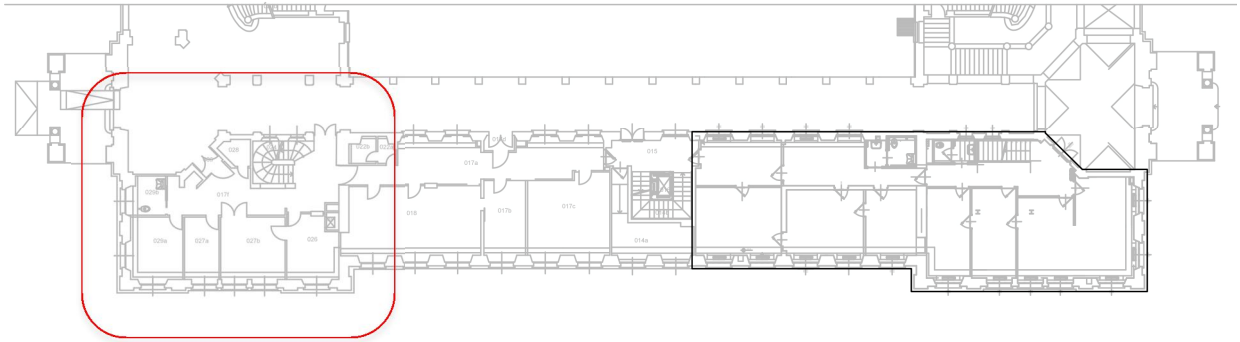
Ritaglio Pianta Piano Terra edificio 2 con segnalazione della zona interessata dal rilievo
